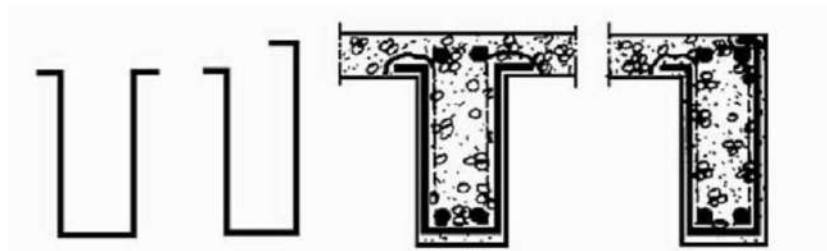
Reforço de viga ao cisalhamento com chapas coladas
